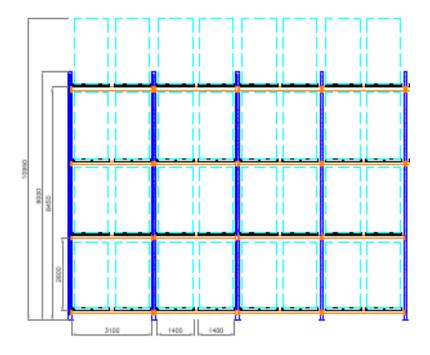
Vista frontal de los racks selectivos de doble profundidad.
